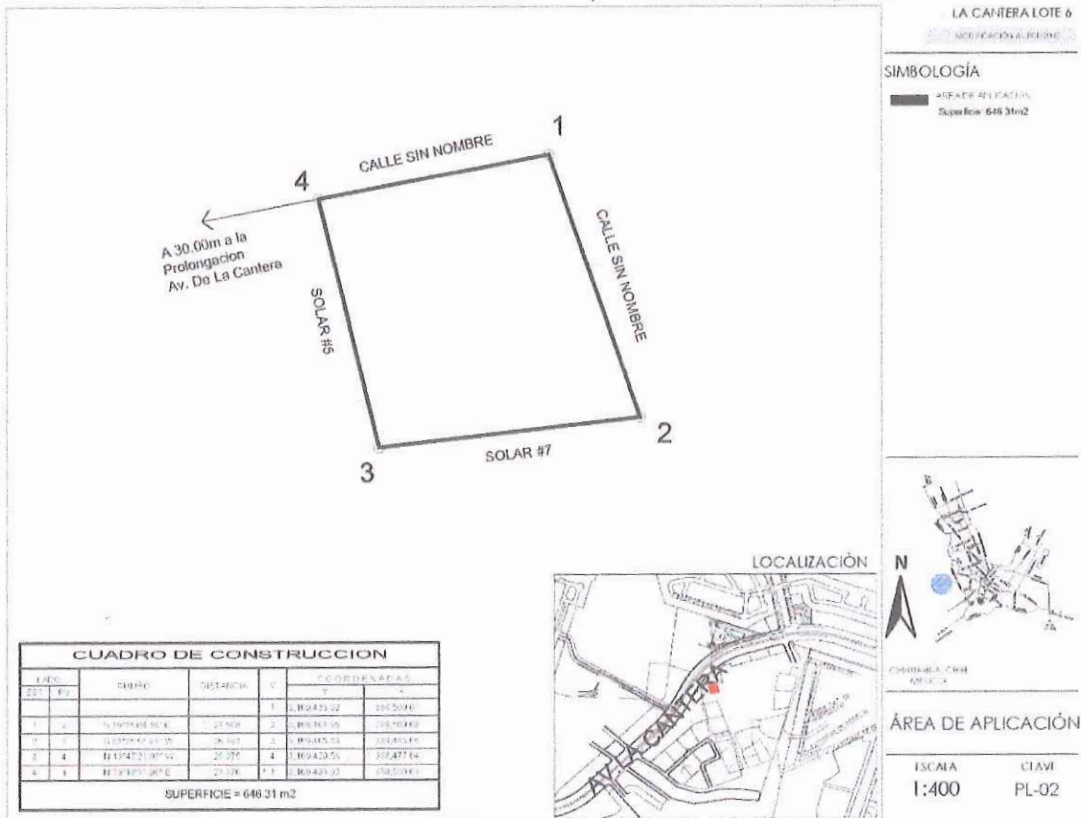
Área de aplicación. - Fuente. Elaboración propia.
